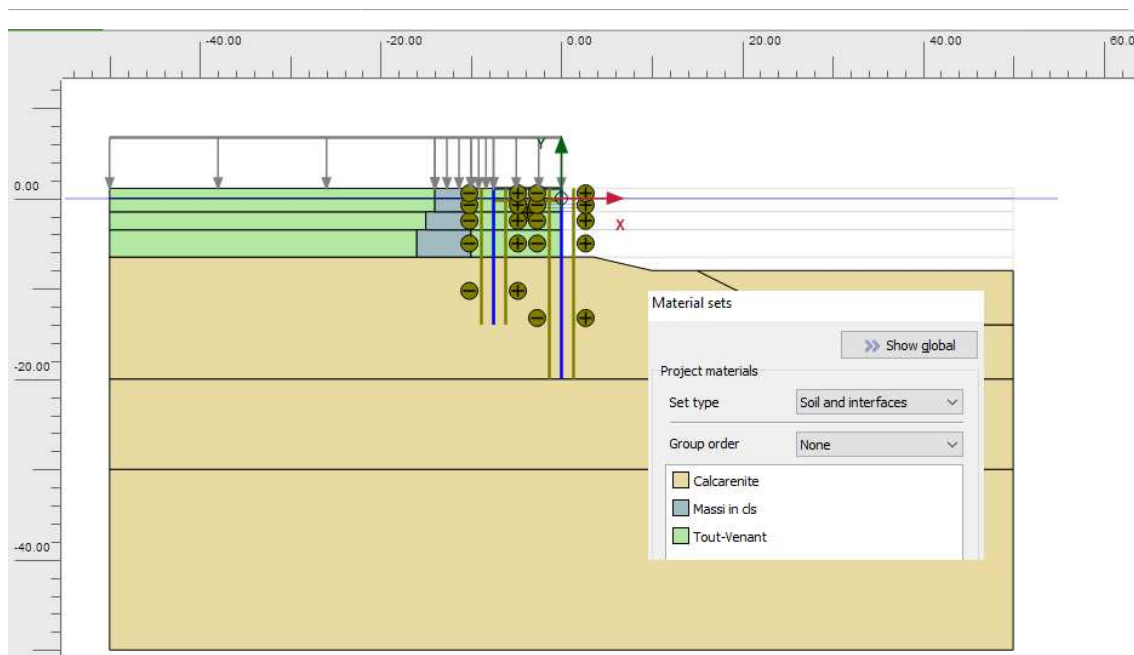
Sezione 1 – Modello geotecnico di calcolo
